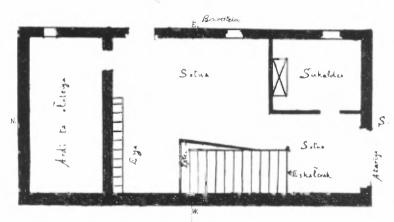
Matxiyo: tipo Akotáin-Zubiaure: planta baja.
